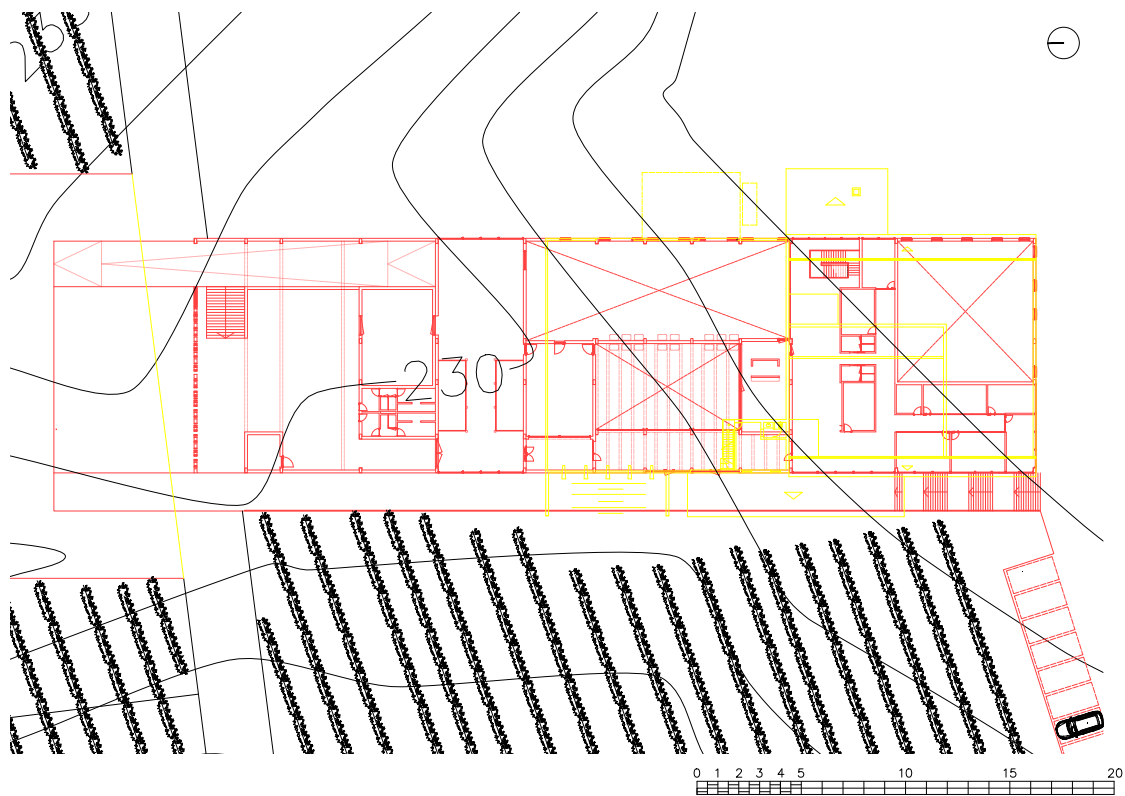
Planta Piso Superior Vermelhos/Amarelos Esc.1:200
